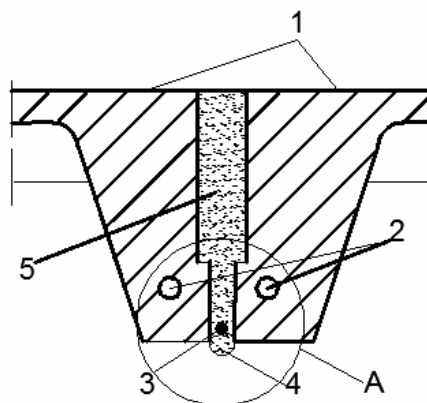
Фрагмент поздовжнього шва між ребрами залізобетонних плит з катодним захистом робочої арматури:
